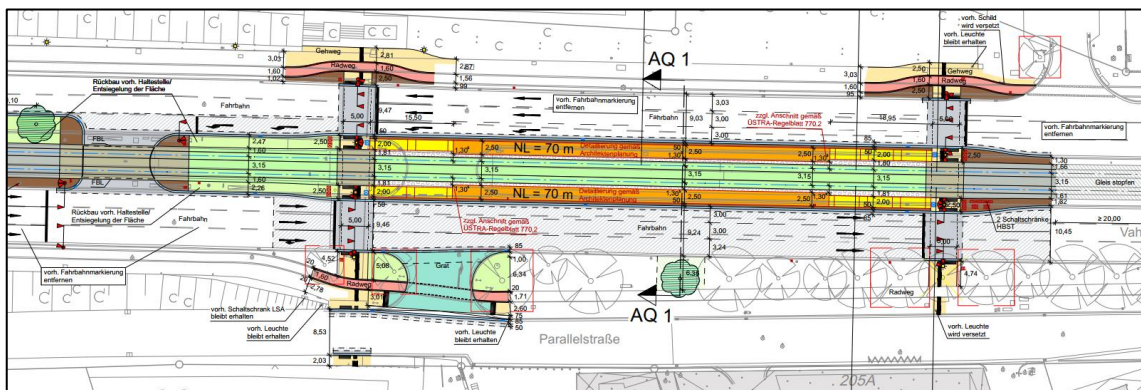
Ausschnitt Lageplan Variante 3 (Entwurfsplanung), VA3LA1a
